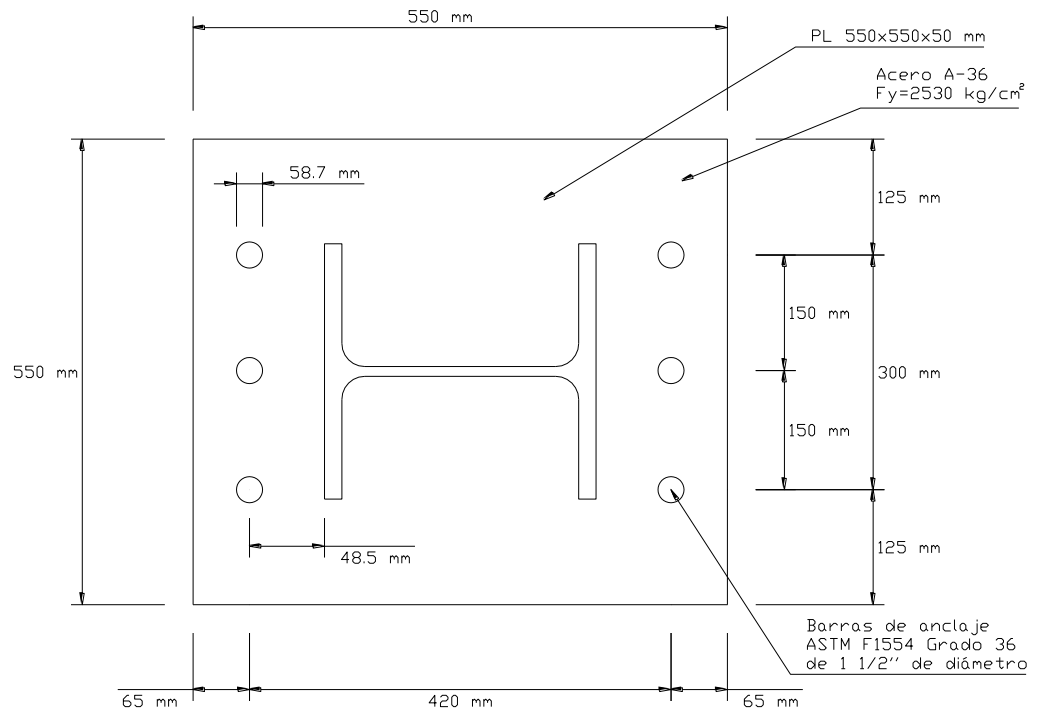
Detallado en Planta del Ejemplo 7.
